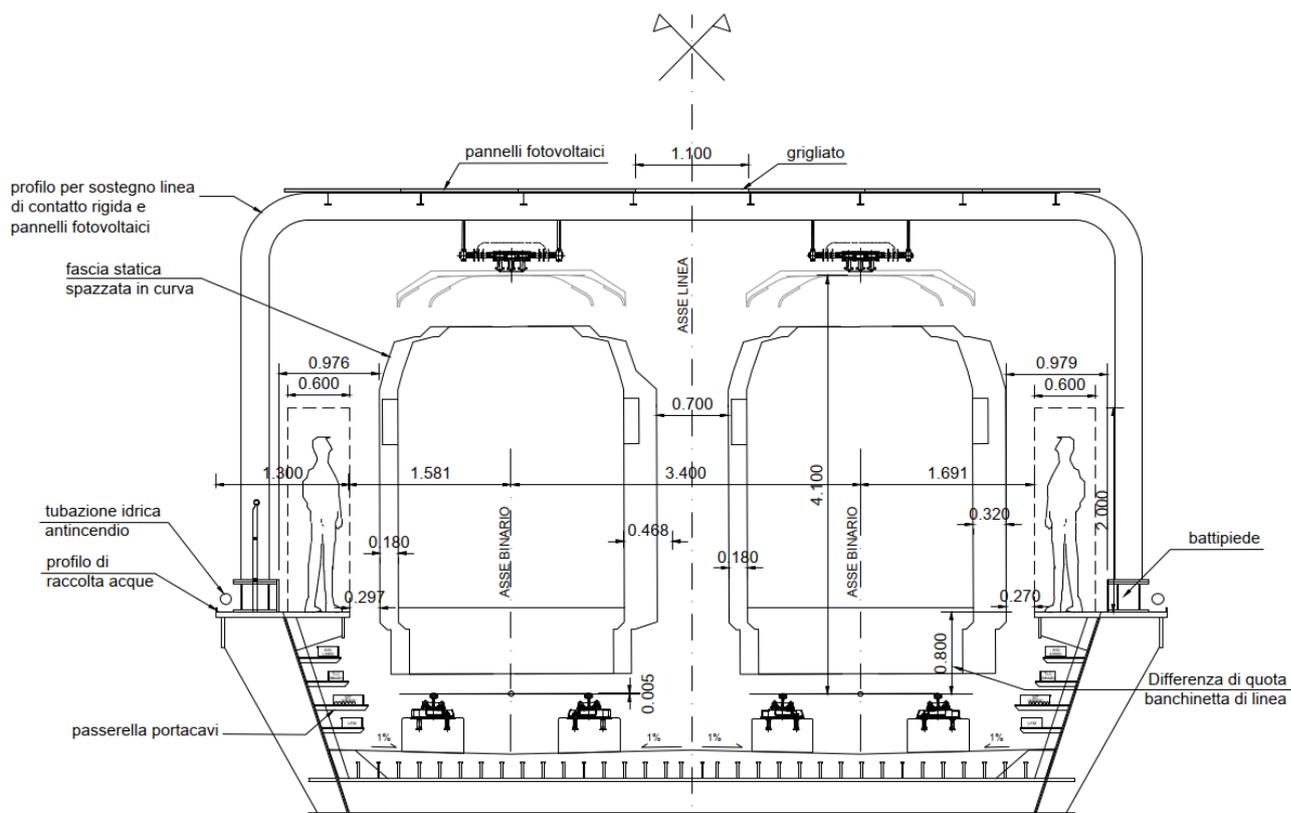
Sezione tipo doppio binario per raggio planimetrico inferiore a 150 m
